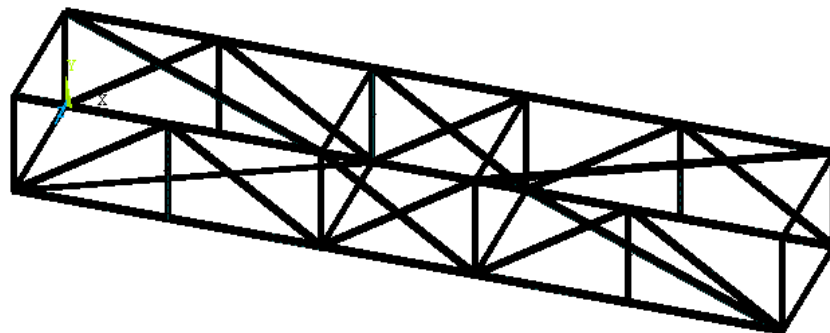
Просторова ферма для розміщення підсиленої циліндричної оболонки
